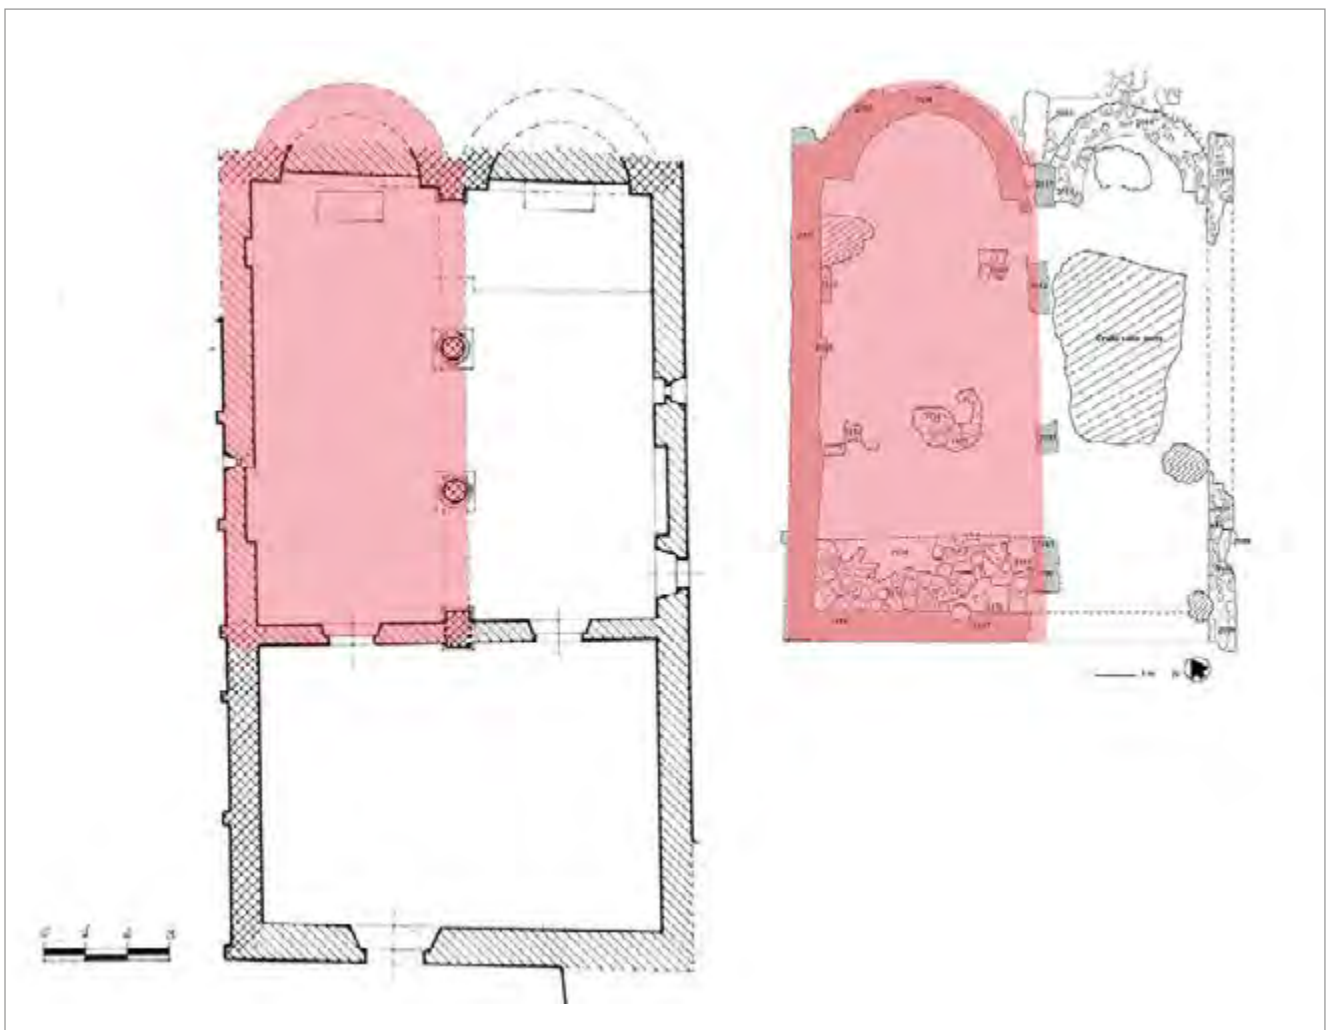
A sinistra planimetria della chiesa di S. Piero in Campo con indicato in rosso l’ipotizzato perimetro dell’originaria prima chiesa (rielaborazione da MORETTI, STOPANI 1972, p. 43); sulla destra, alla stessa scala, planimetria della chiesa a due absidi nel sito in località Torre di Donoratico con evidenziato in rosso l’edificio mononave più antico (rielaborazione da NOTARDONATO 2004, fig. 10, p. 35).
